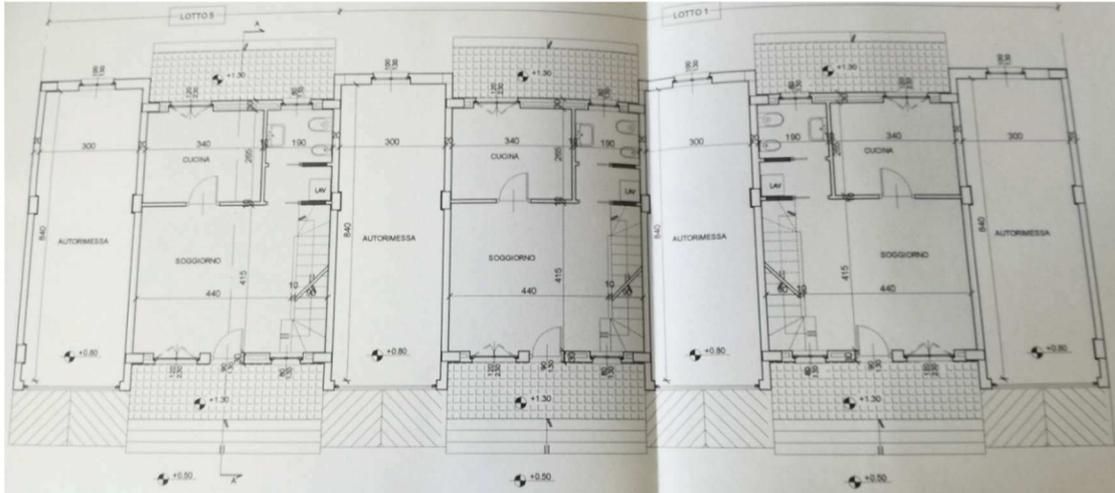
Pianta piano terra edificio trifamiliare situato in frazione Mezzi Po
